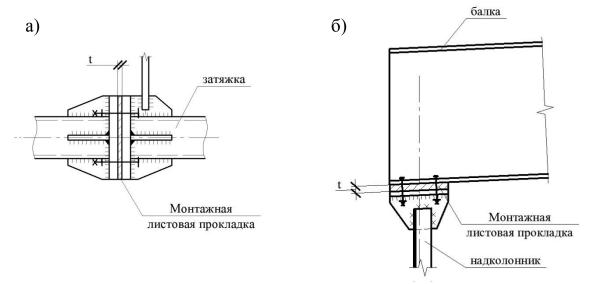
Создание предварительного напряжения в конструкции смыканием зазоров в монтажных стыках: а) затяжки; б) надколонника с балкой
